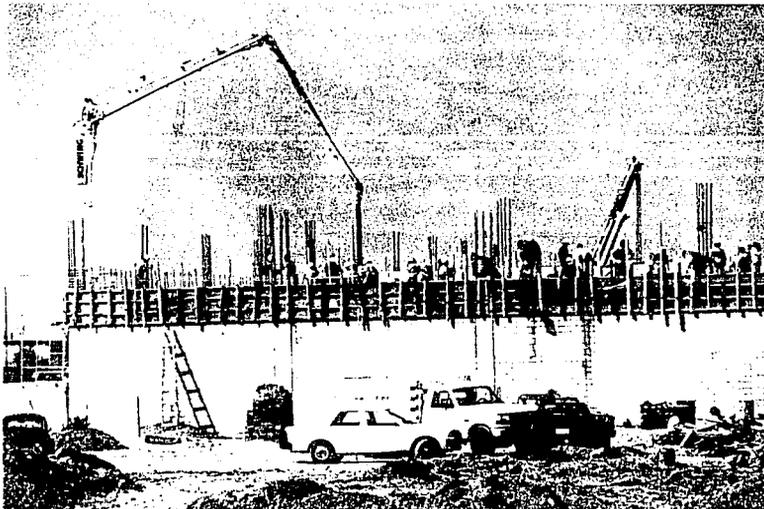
CIMBRADO Y ARMALO DE TRABES DE LA LAMA DE
